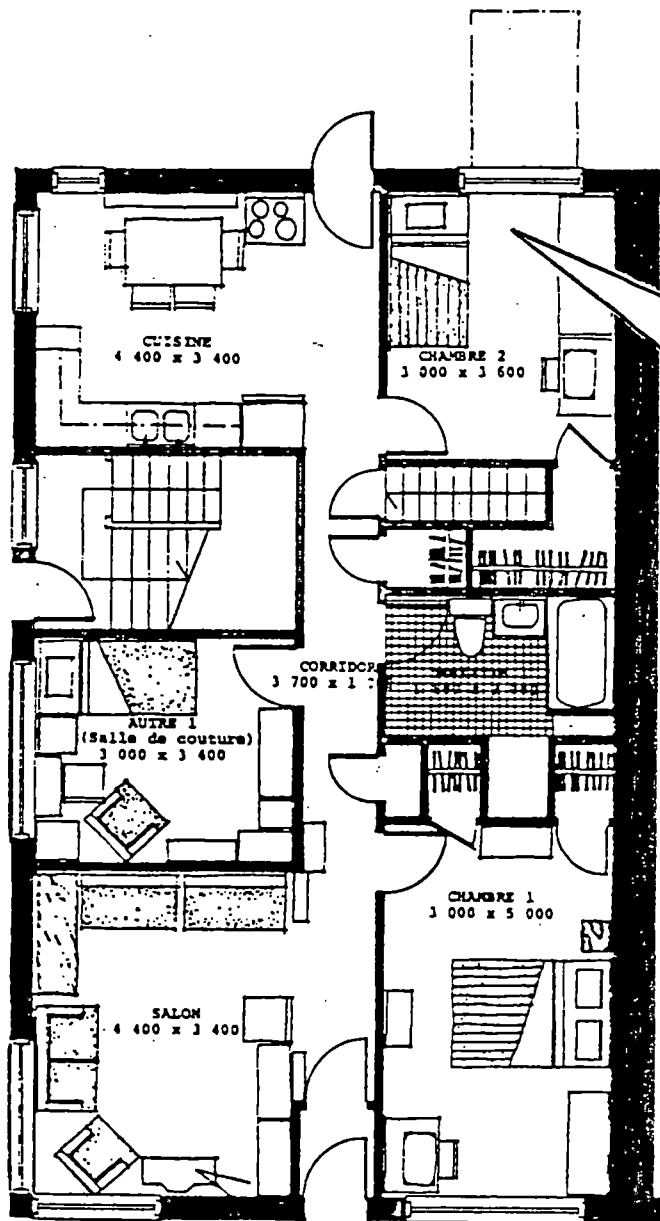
Plan du sous-sol d'un duplex, Famille 17 (1770). Échelle 1/100.
